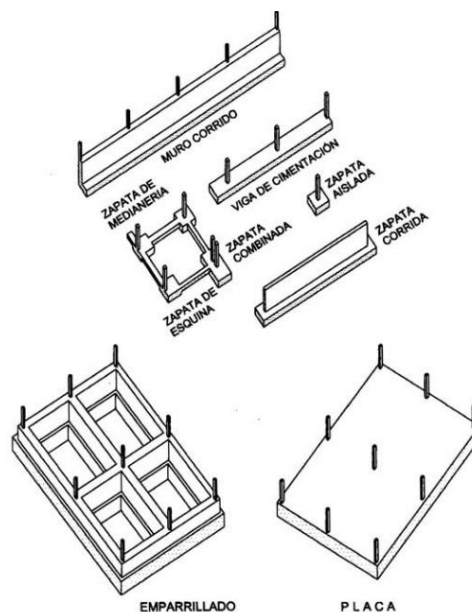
tipos de cimentaciones superficiales, zapatas, vigas, muros, emparrillados y placas. Fuente: Calavera, 2000.
